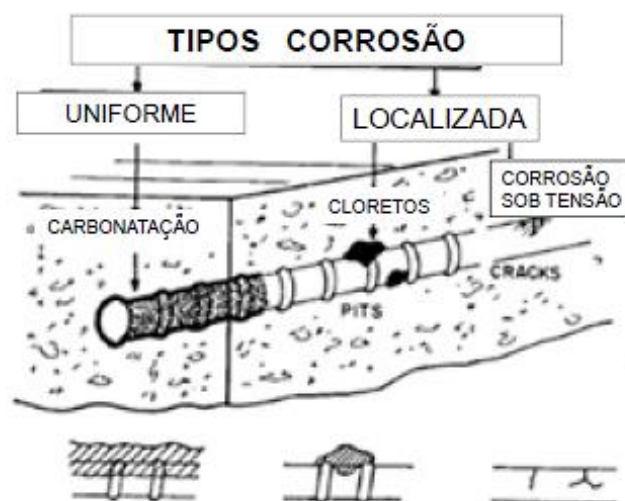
Tipos de corrosão das armaduras (Silva, 2013)
